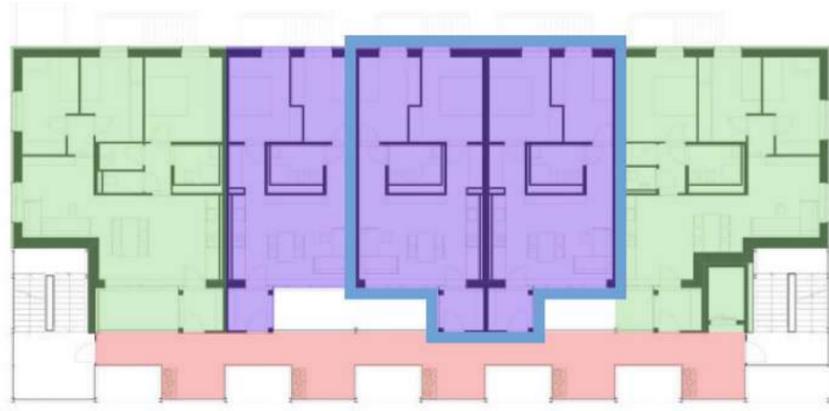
Posibles distribuciones de planta y apartamentos. Fuente: © Delugan Meissl Associated Architects, modificación propia.
